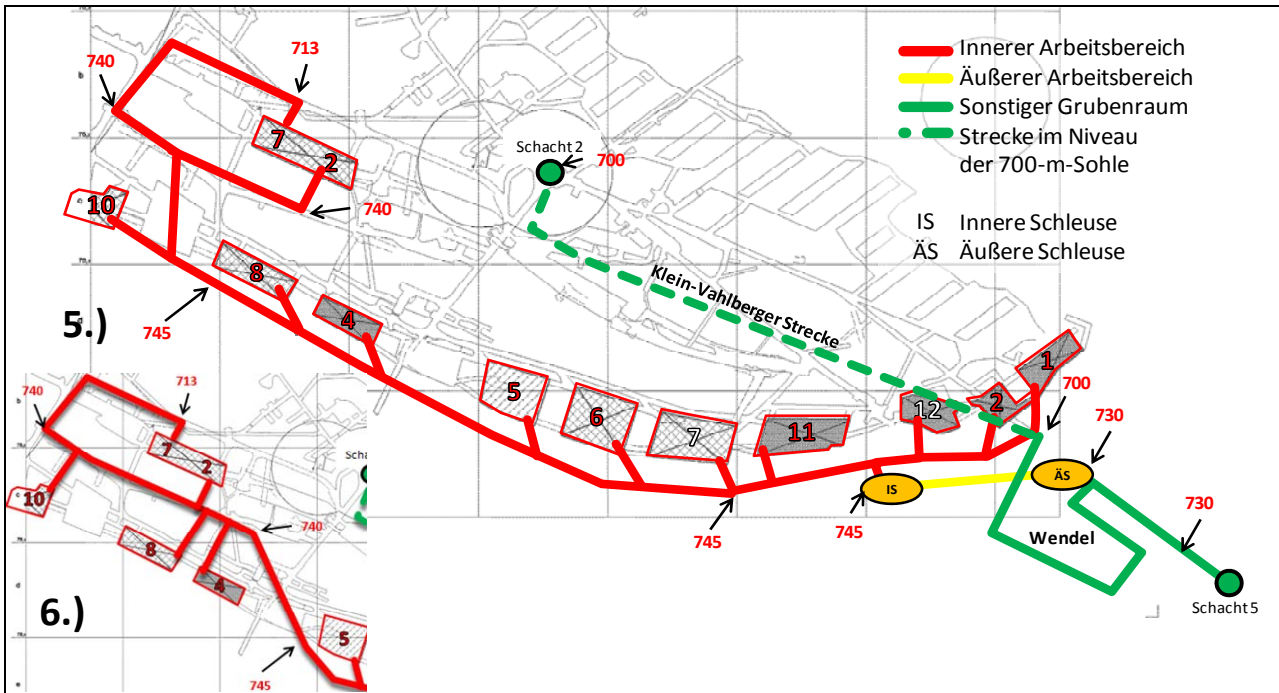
Schematische Darstellung der Varianten 5 und 6 – Rückholung von Süden (Hintergrund: Grundriss der 750-m-Sohle).
